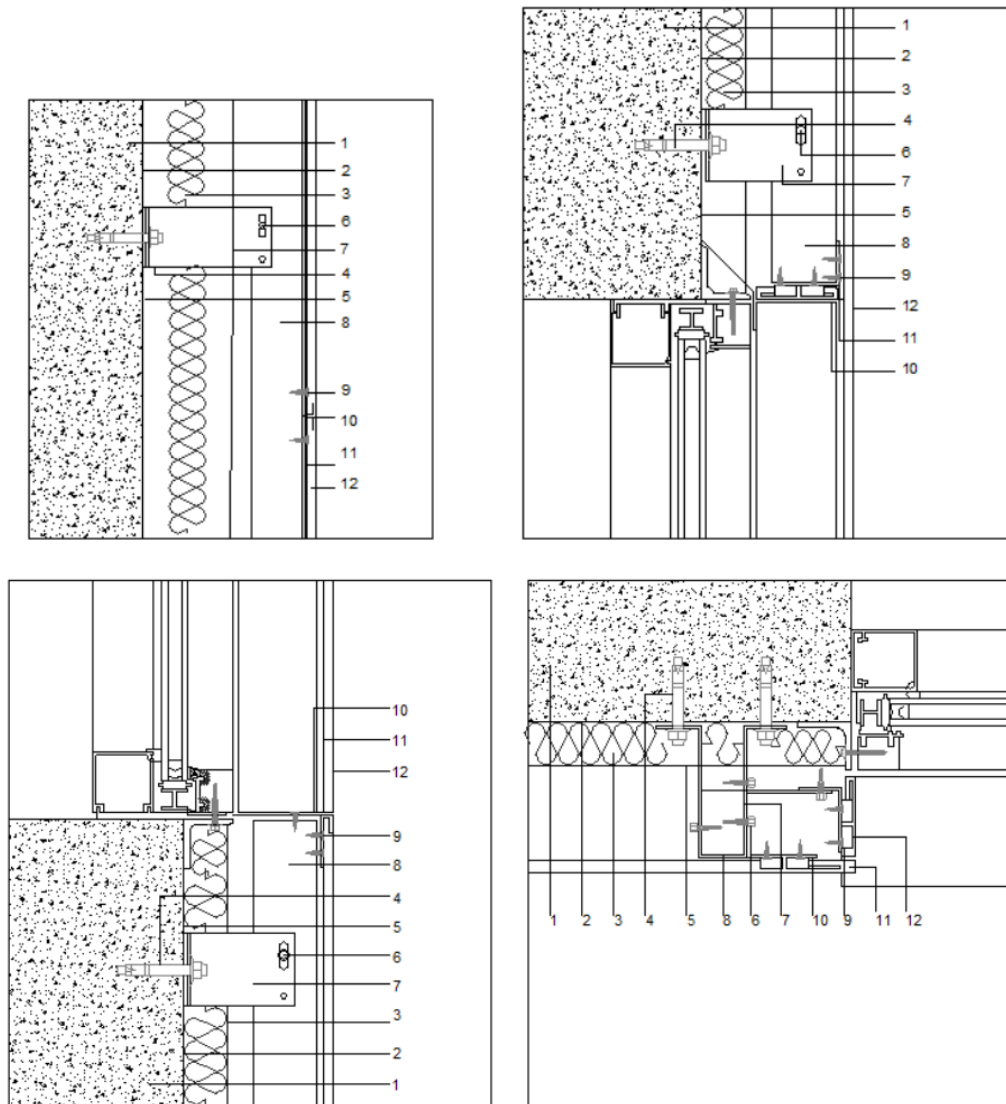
Pormenores de Execução do Sistema de Fachada Ventilada [67].
